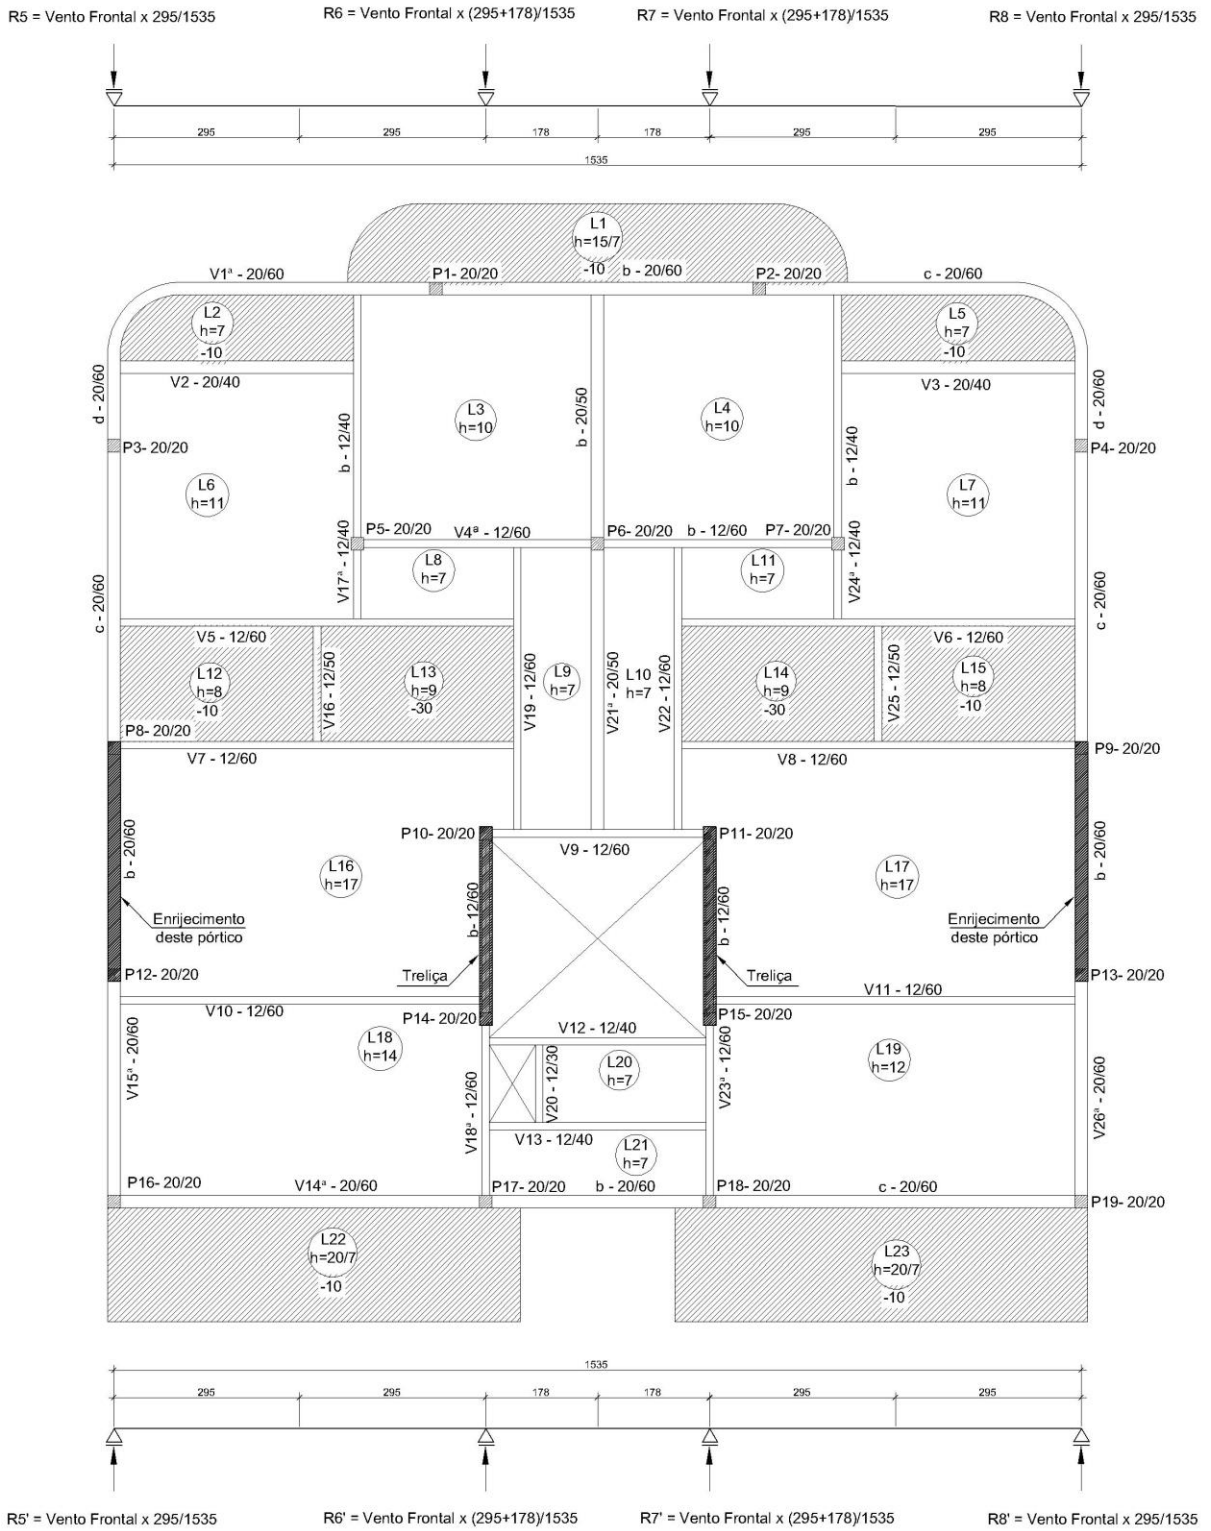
Cargas de vento distribuídas para cada pano de laje na fachada menor.
